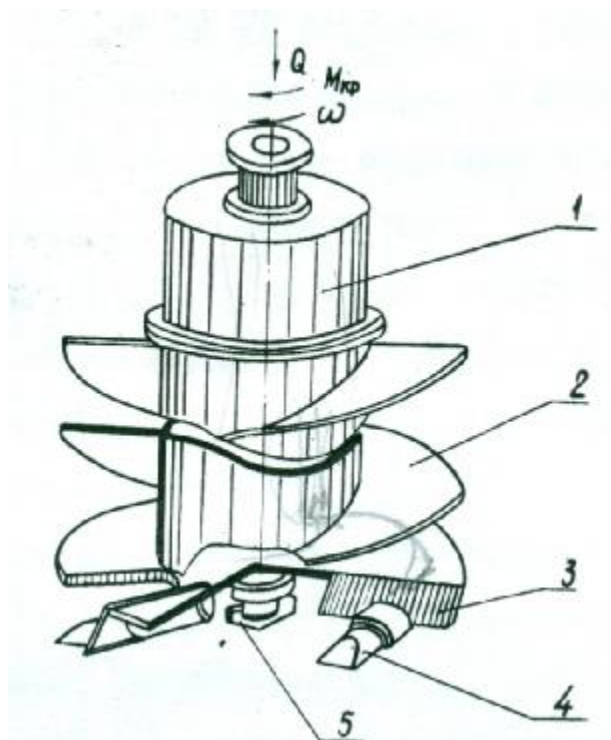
Конструктивная схема бурового рабочего органа: 1 – корпус; 2 – накопитель грунта; 3 – лемех; 4 – ударный инструмент; 5 – забурник.
